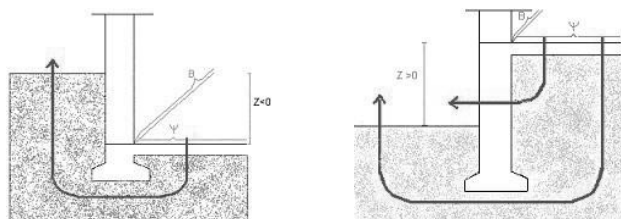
Pavimento em contacto com o terreno sem isolante térmico.
